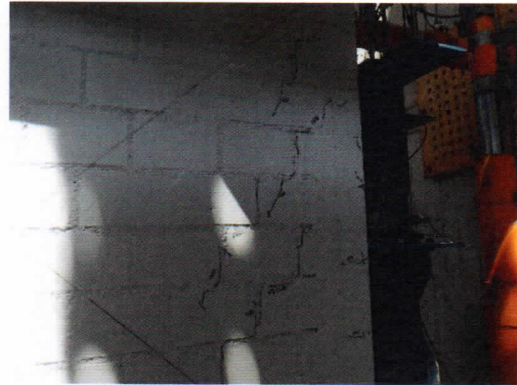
Formación de grietas diagonales en el mortero en la parte superior Oeste de la cara Norte para una distorsión 1/1100.
